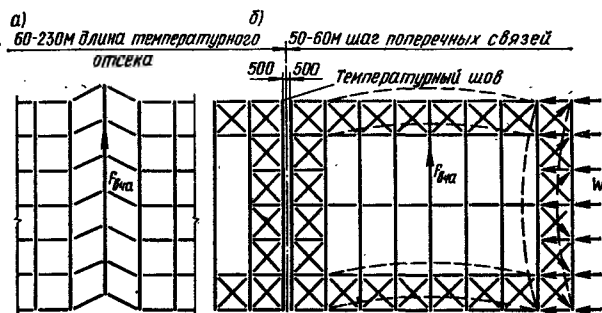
Поперечная деформация каркаса от местной крановой нагрузки
